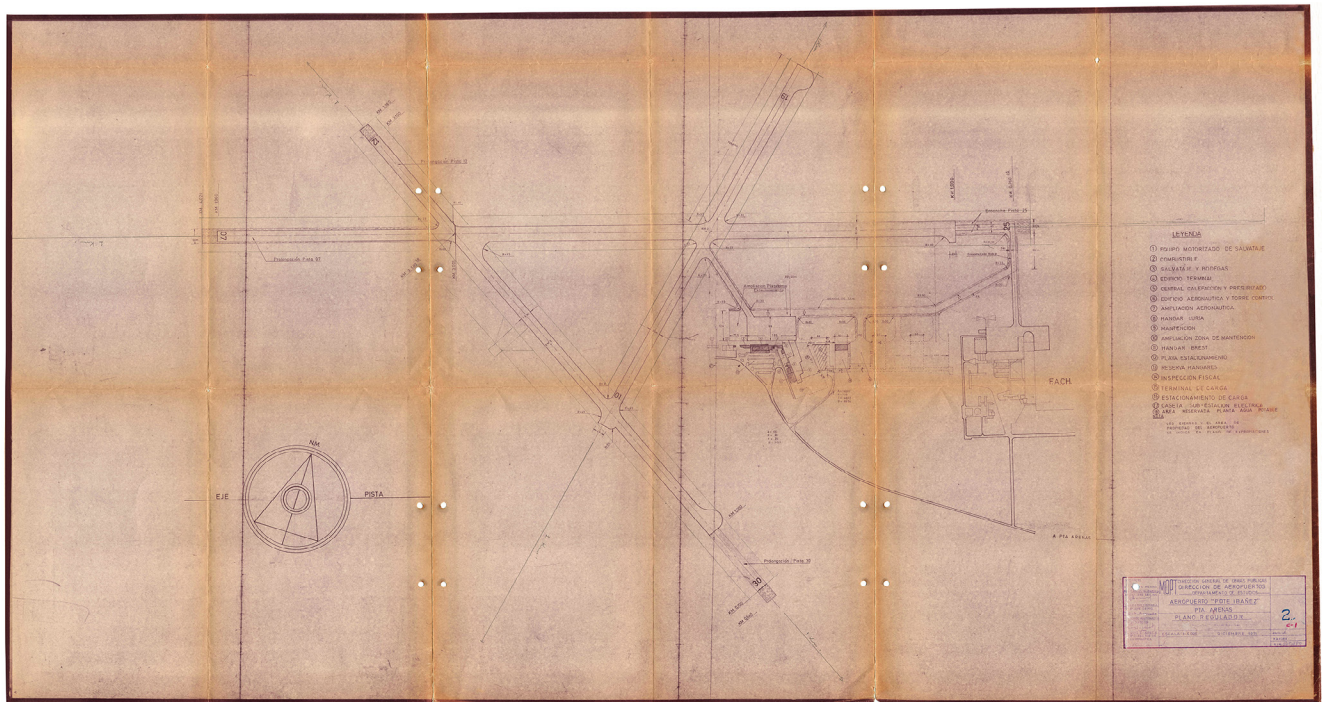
Plano regulador (fuente: Ministerio de Obras Públicas, 1971).
